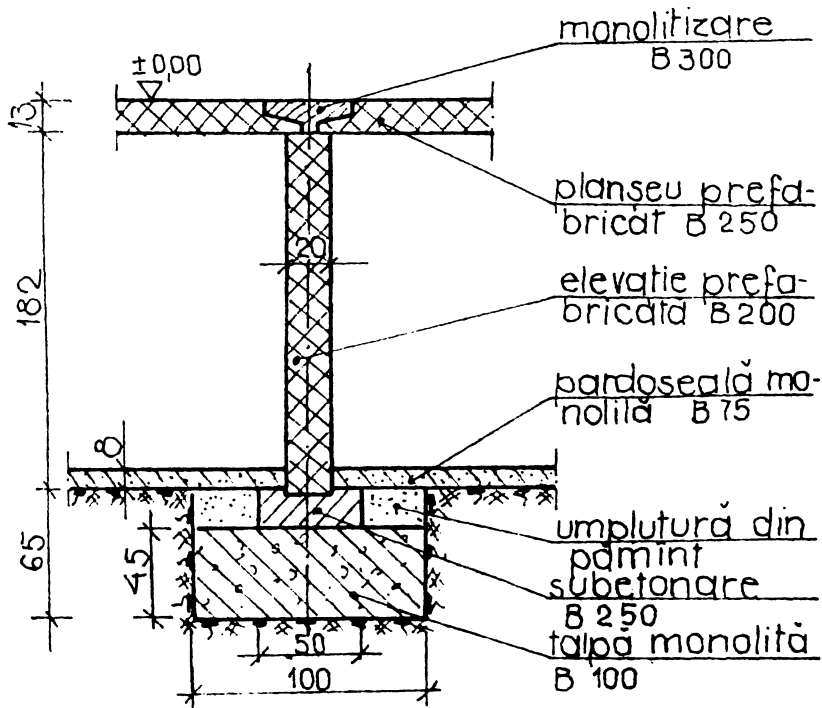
Infrastructură cu fundații monolite și elevații prefabricate. [47]
